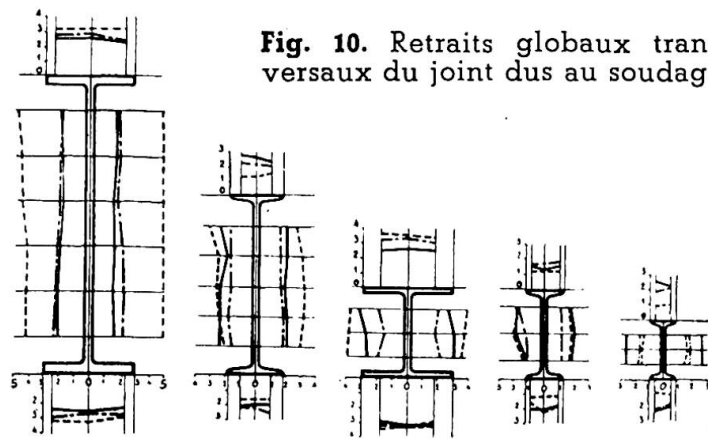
Retraits globaux transversaux du joint dus au soudage.
